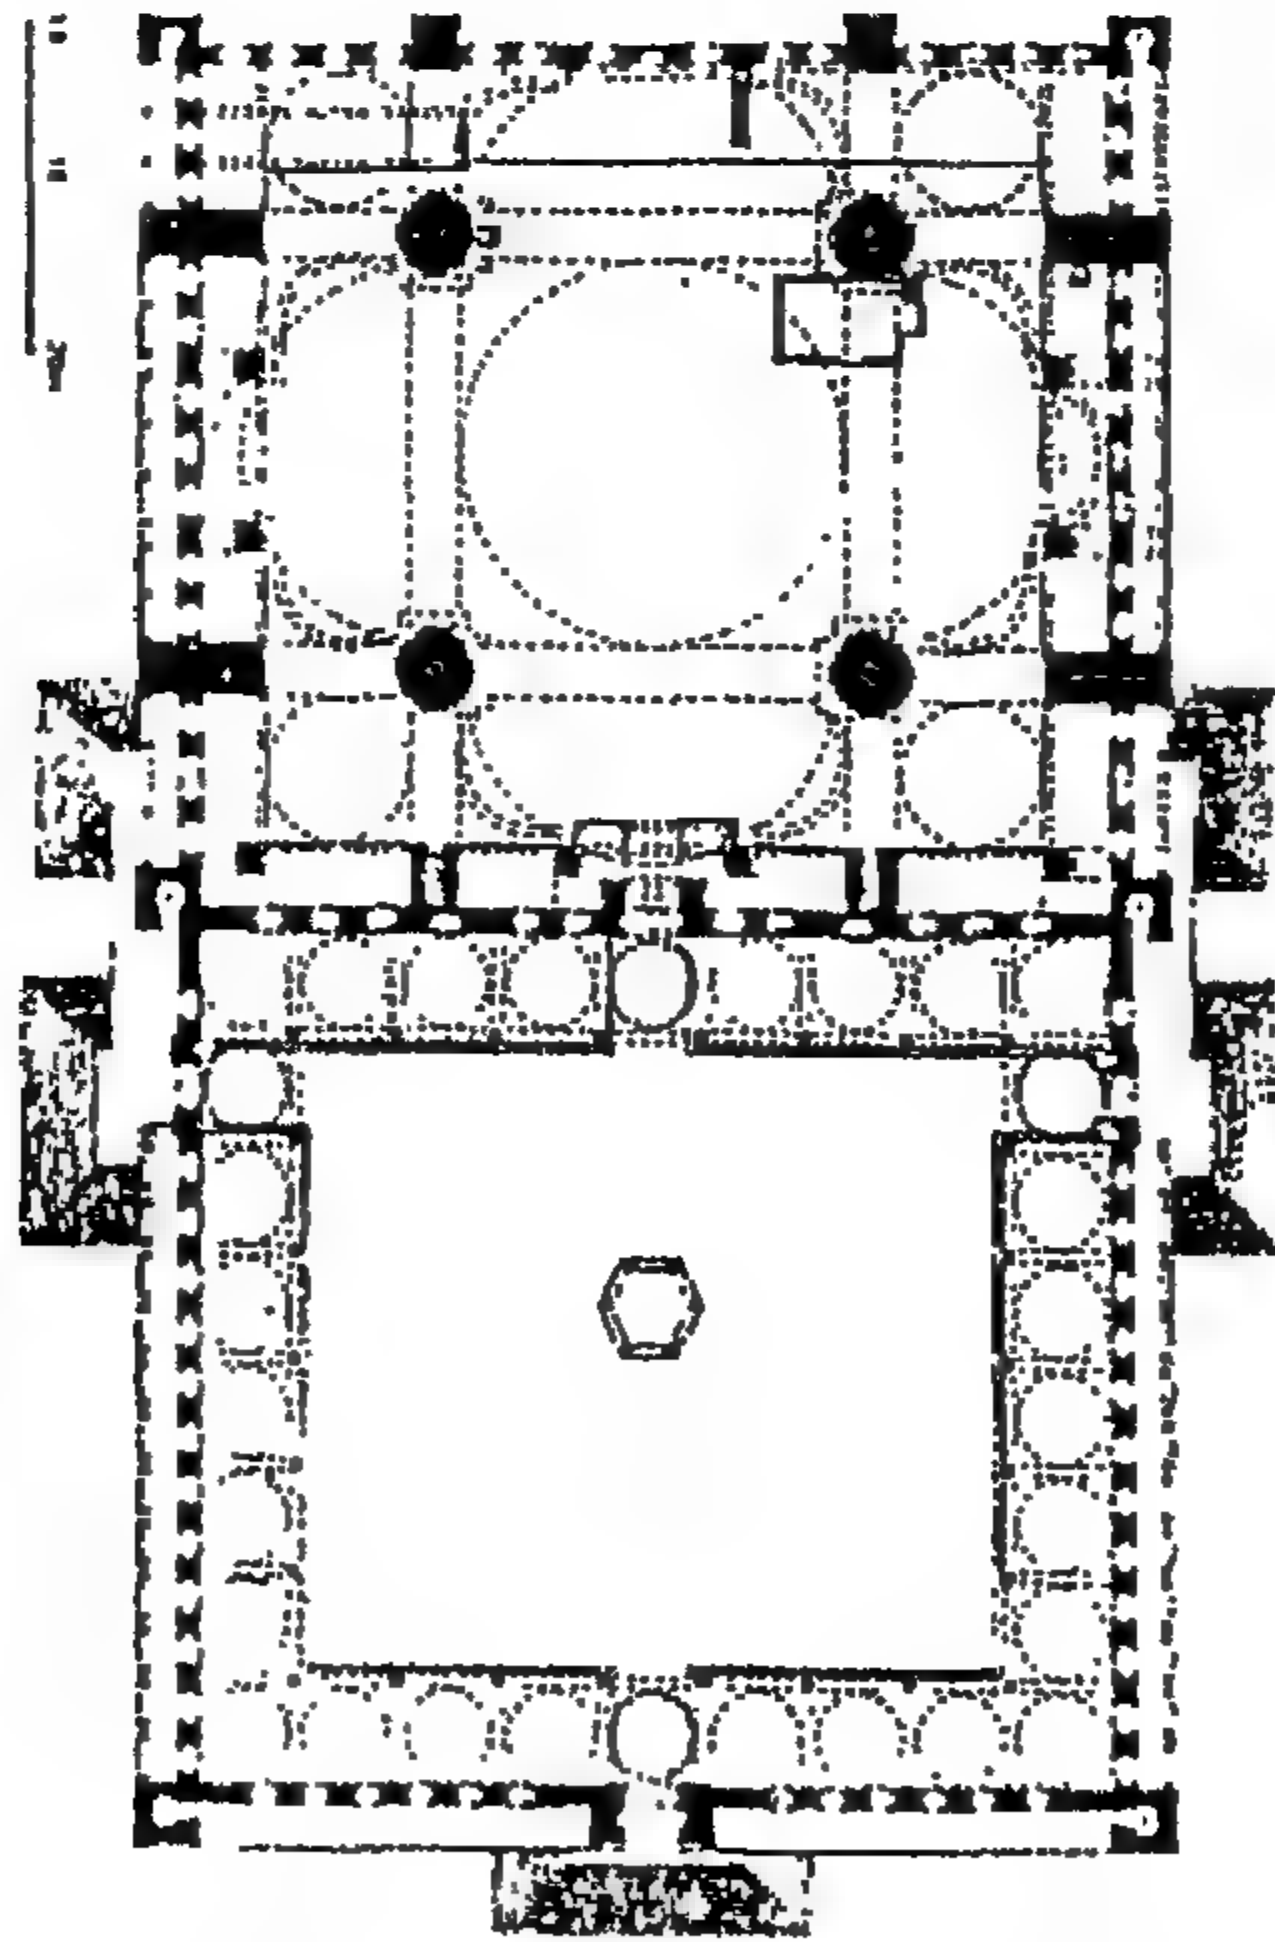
مسقط أفقي لمجمع (كلية) السلطان محمد الفاتح بإستانبول .
